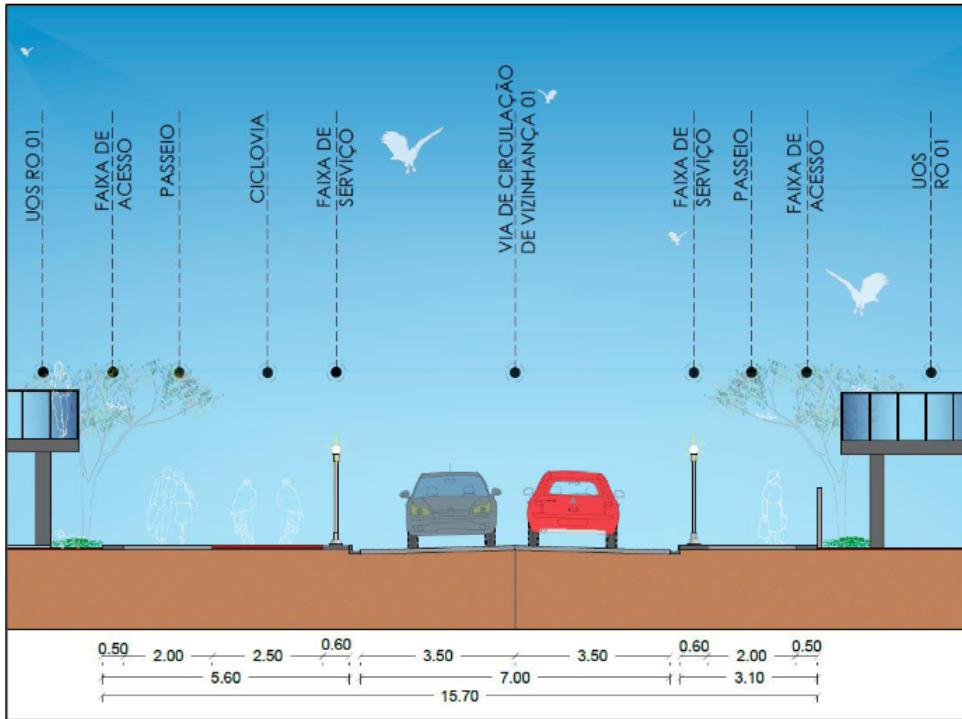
Perfil viário da Via de Circulação de Vizinhança 1. Fonte: MDE 241/2022.
